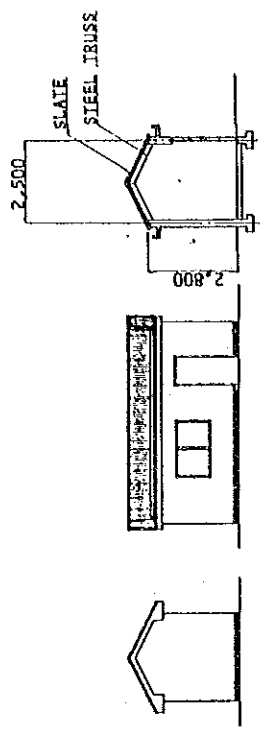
資機材用倉庫および設備管理用倉庫 平面図および立面図
